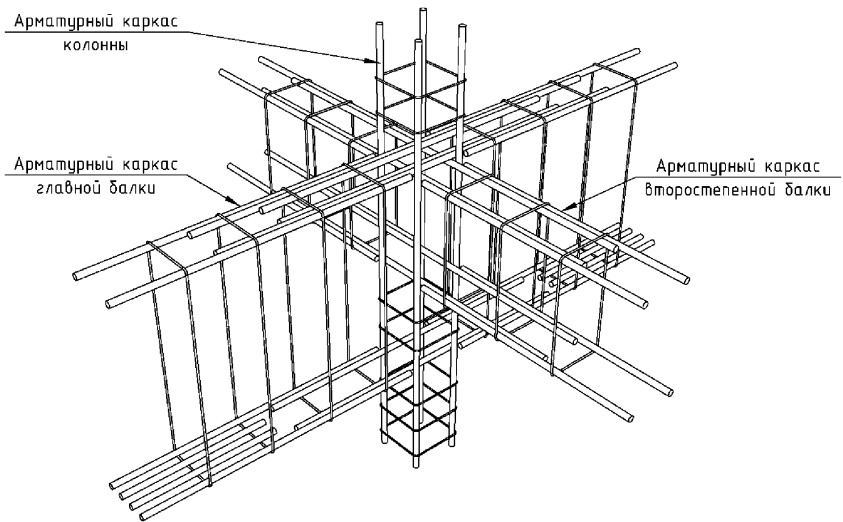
Детальное армирование внутреннего узла сопряжения балок с колонной
